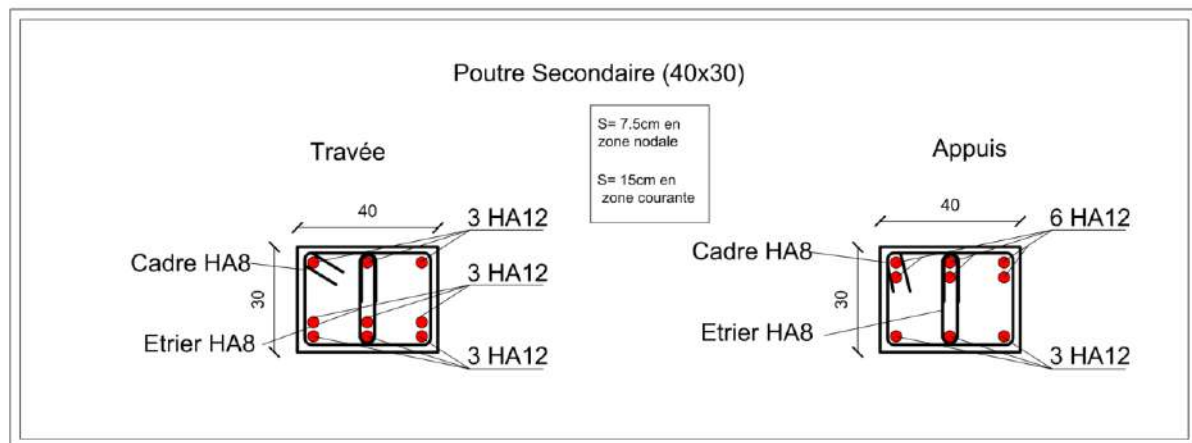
Schéma de ferrailage des poutres secondaire
